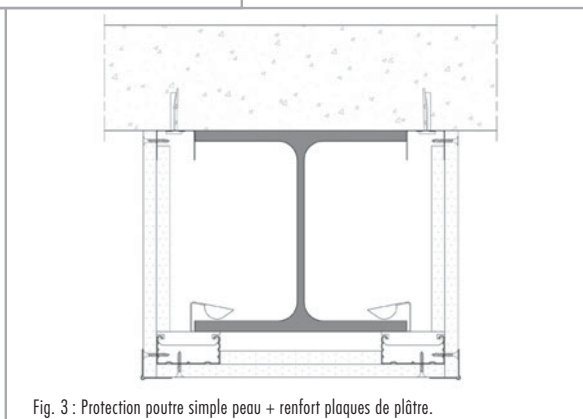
Protection poutre simple peau + renfort plaques de plâtre.
